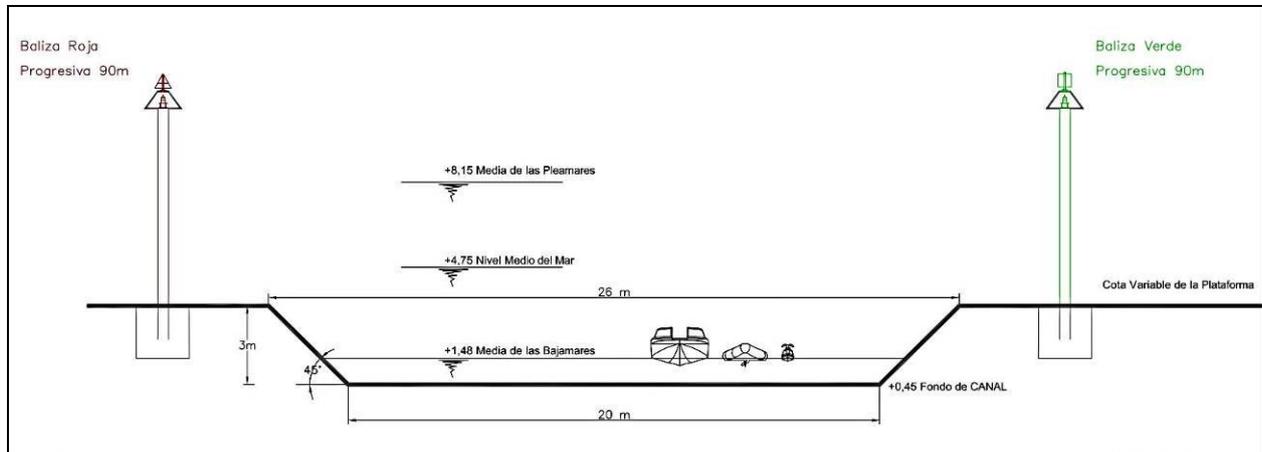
Sección transversal tipo, canal de acceso. Fuente: elaboración propia
